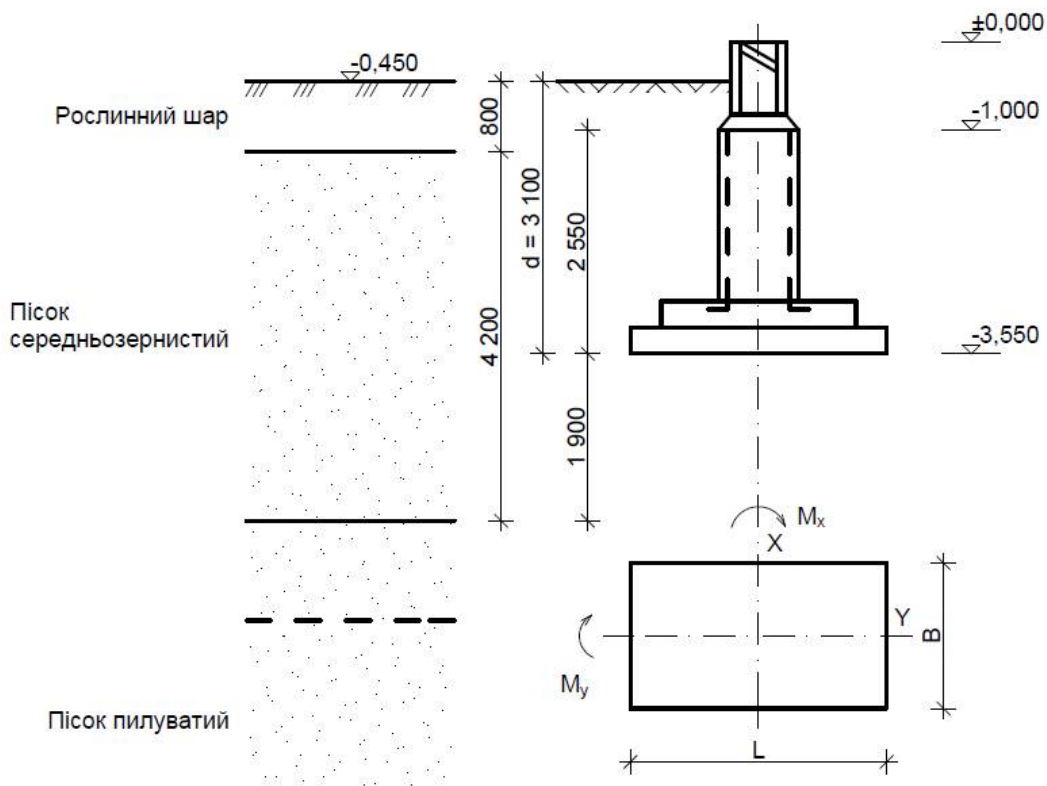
Схема розташування фундаменту в ґрунті і навантажень, діючих по обрізу фундаменту
